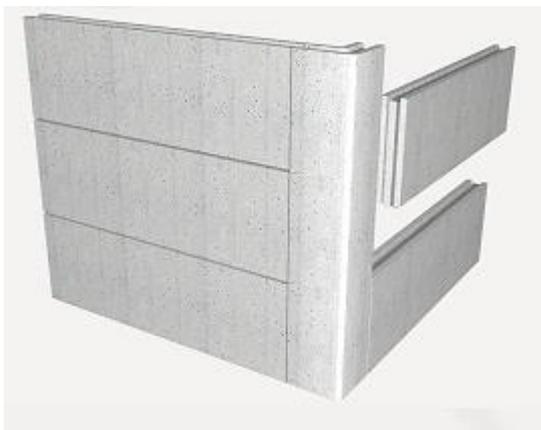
Paneles hormigón prefabricado. Fuente: CYPE generador de precios
